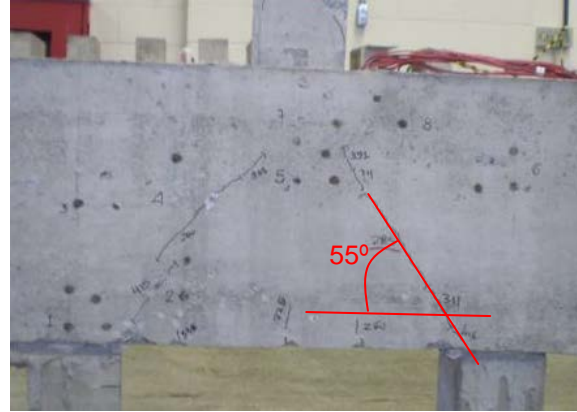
Detalhe da altura de propagação da fissura inclinada B110P125R1 (lado norte)
